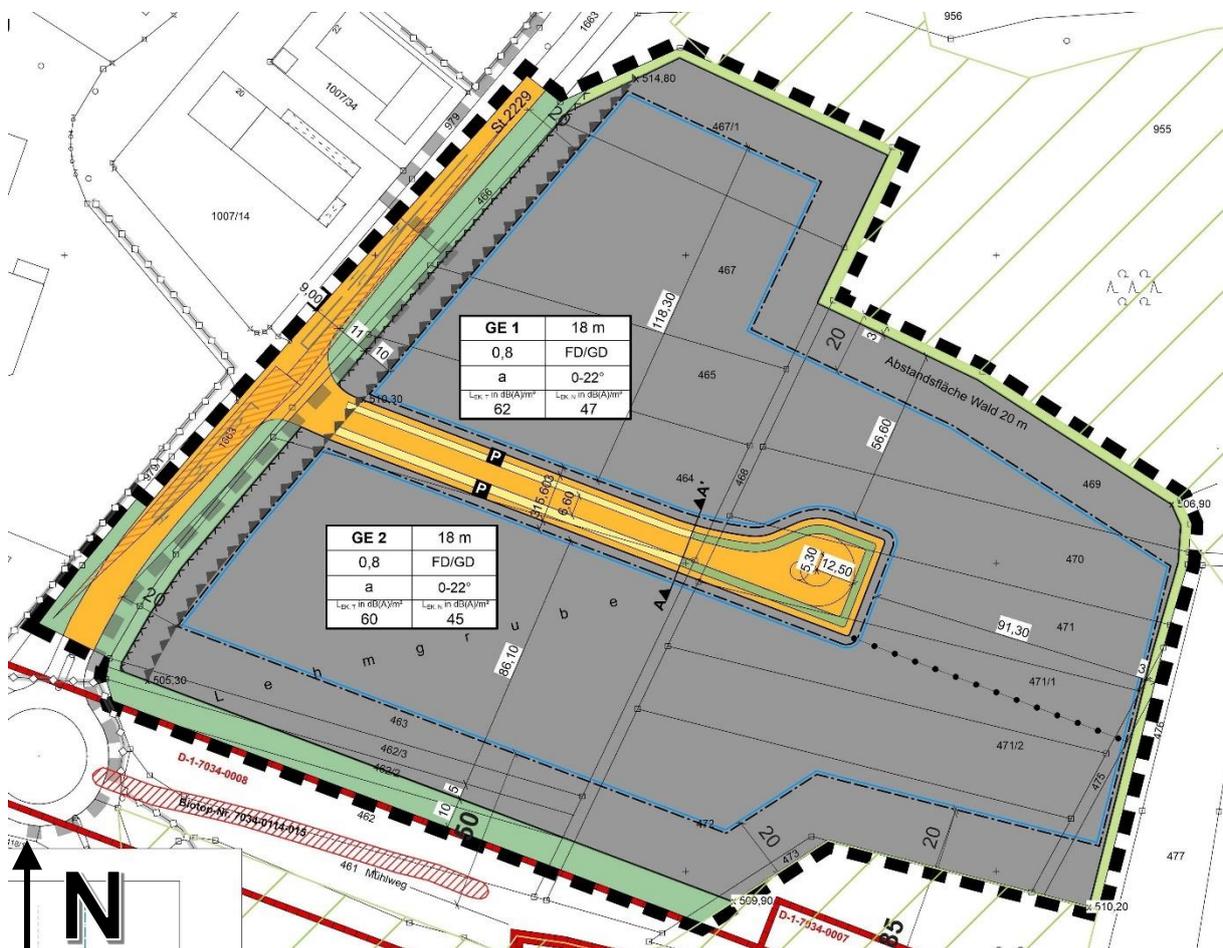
rechtskräftiger Bebauungsplan, ohne Maßstab
